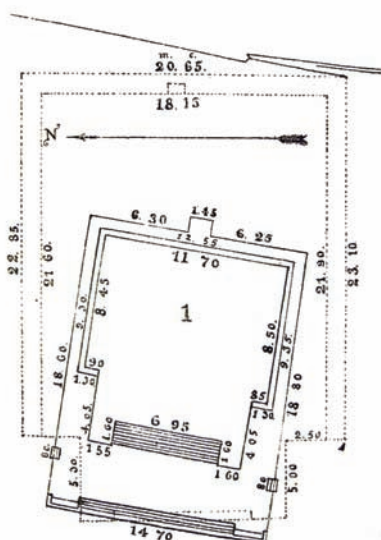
Planta de Santa María según plano de Leopoldo Batres (Tomado de Batres, 1904: Plano adjunto de la Lámina IX).
